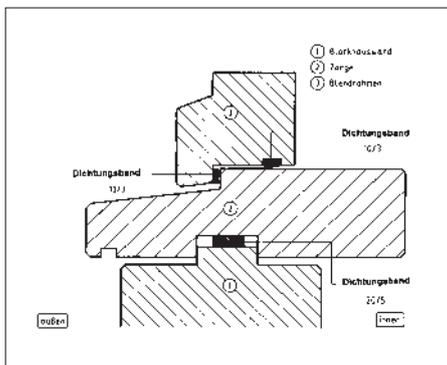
Unterer Fensteranschluß an eine Blockhauswand – Vertikalschnitt
